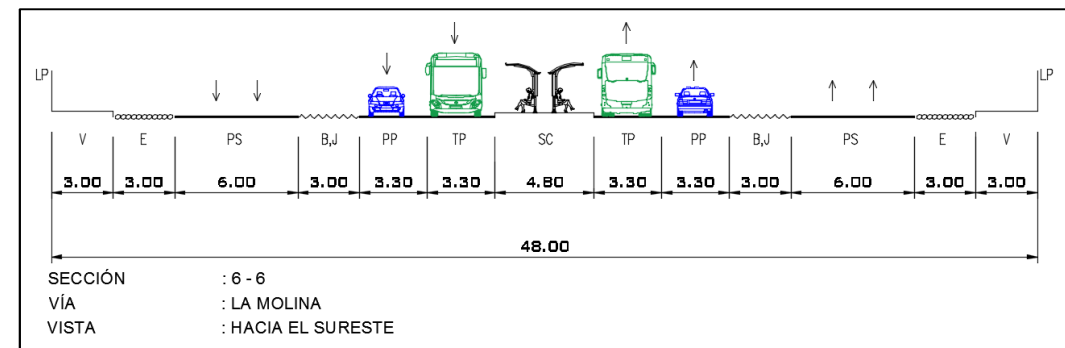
Sección 6-6, Corredor 2. Fuente: Propia.
